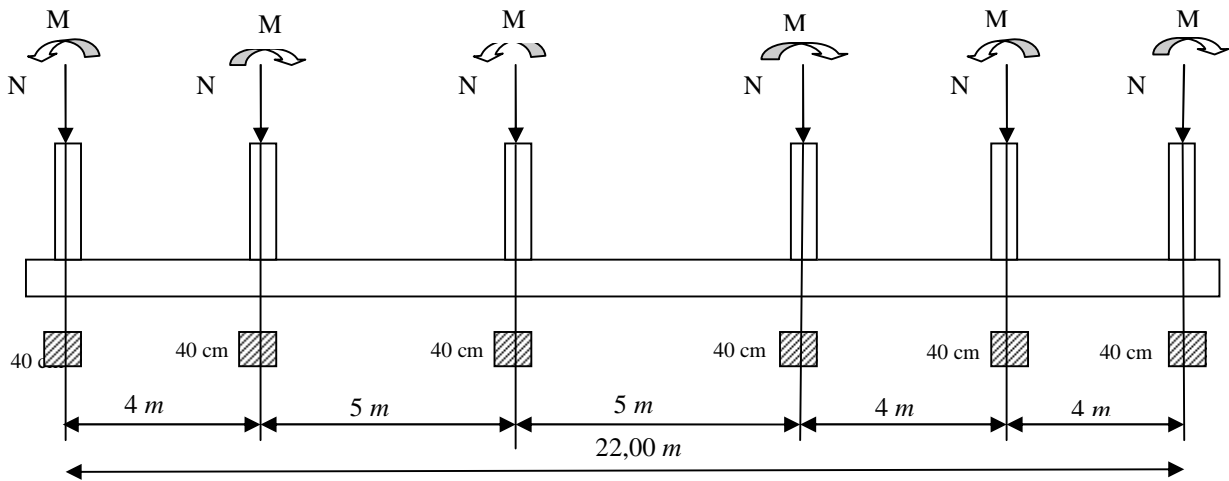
La surface des semelles filantes sous poteaux (file des poteaux les plus sollicitées)
